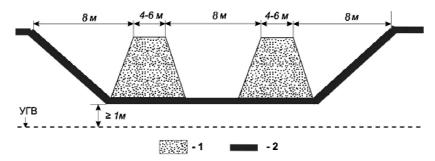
Схема (в разрезе) расположения разрезающих полос в шламовом амбаре или временном шламонакопителе при переработке отходов бурения: 1 – грунт; 2 – гидроизоляция; УГВ – уровень грунтовых вод
